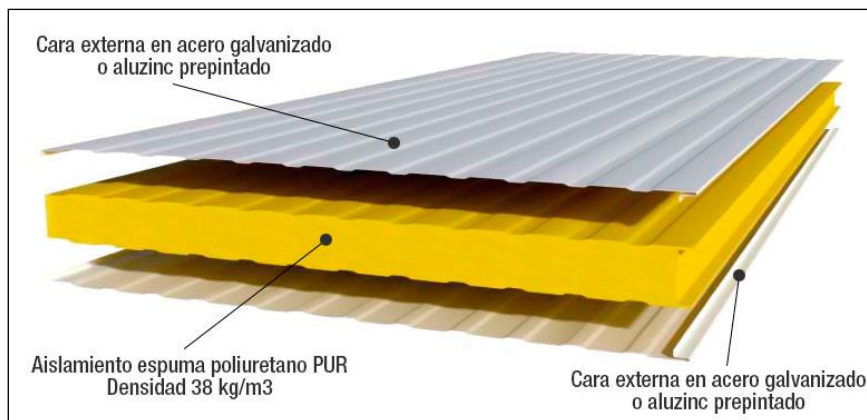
Composición panel tipo sándwich termoaislante de poliuretano - PUR Tomado de Aisla.pe (2019). Panel sándwich termoaislante de poliuretano – PUR (Fuente: AISLA.PE, 2019).
